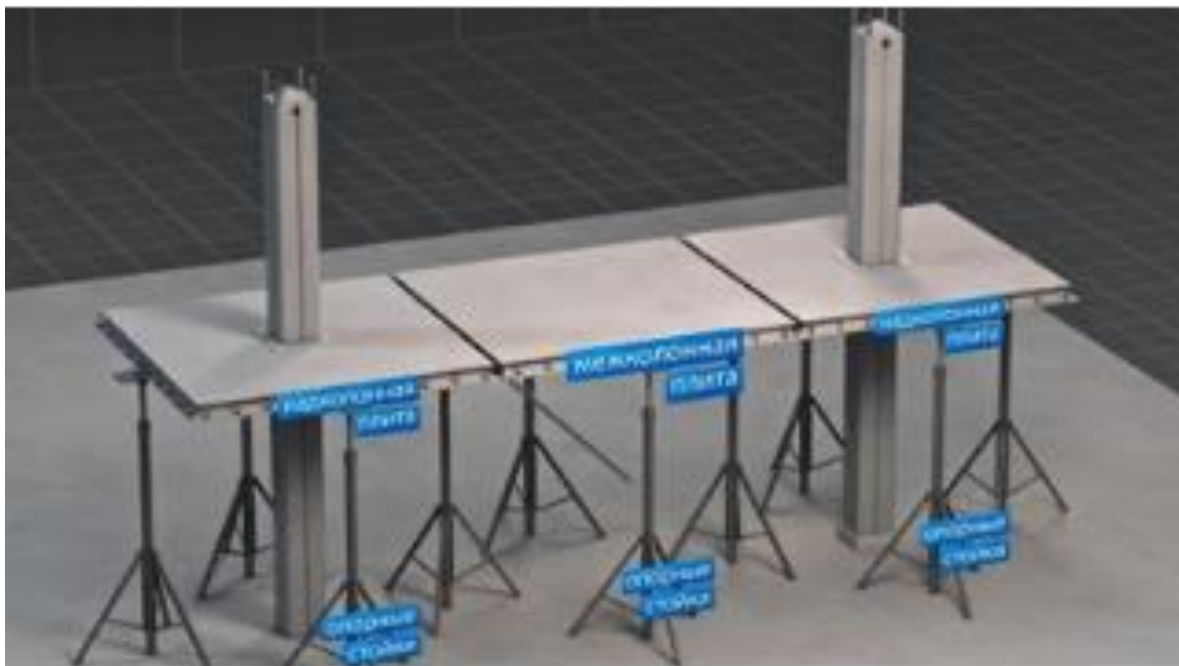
Установлена між надколонними плитами міжколонна плита
